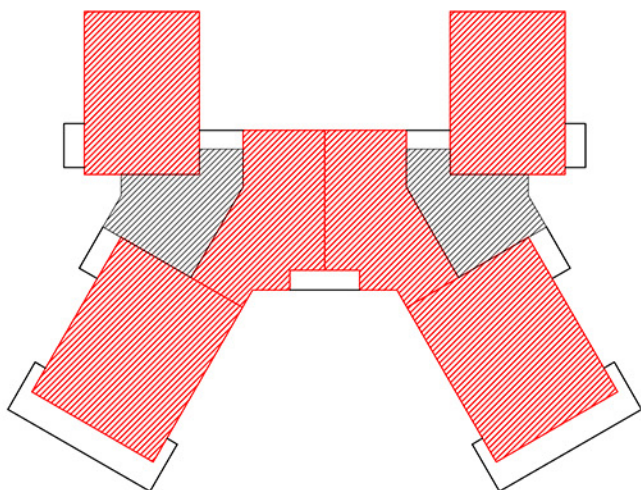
planimetria delle zone termiche che caratterizzano l'edificio dal 17° p.f.t al 18° p.f.t.
